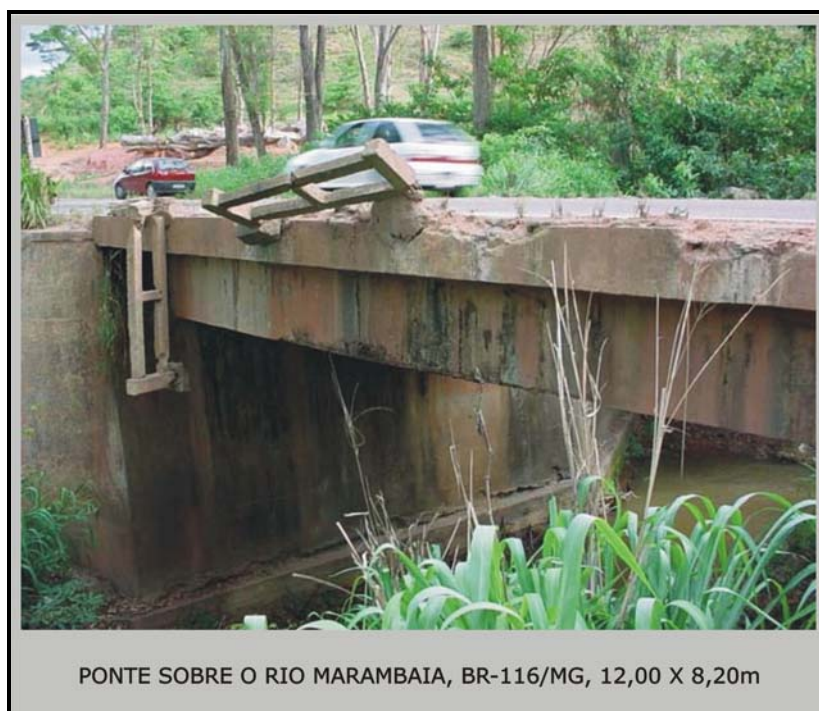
Guarda-corpos destruídos apesar da correta proteção por barreiras New Jersey
